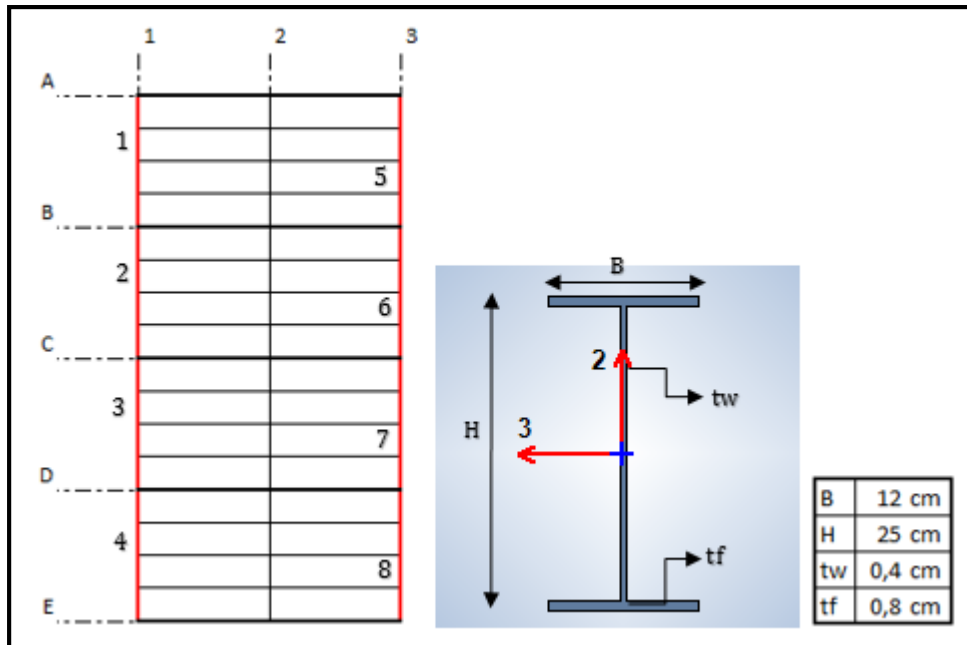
Dimensiones de vigas perimetrales en "Y" con pórticos arriostrados.
